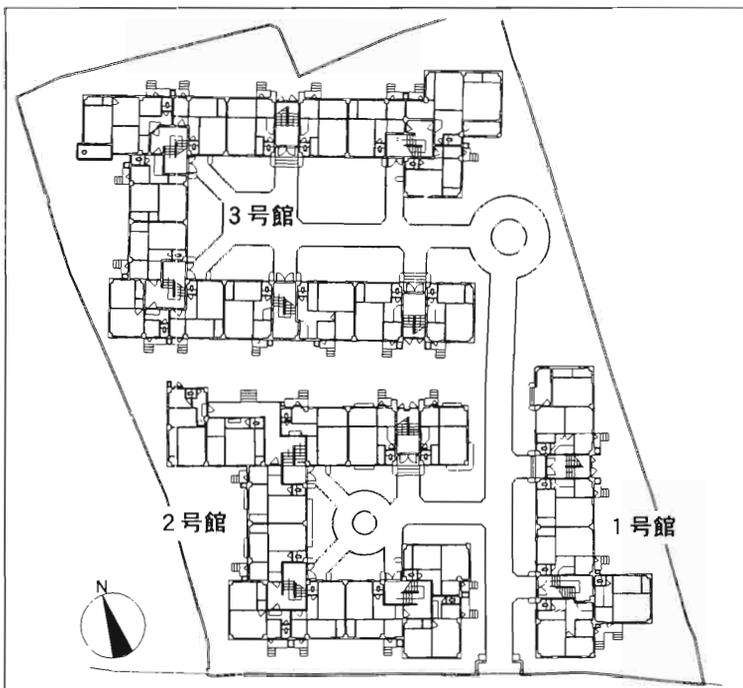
鶯谷アパート復元配置図兼1階平面図 S=1:700
